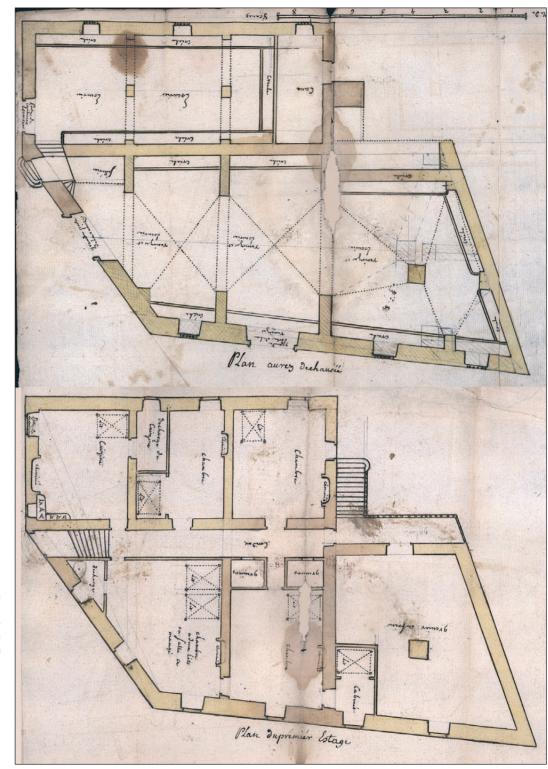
Plan de l'auberge de Laurent Parlier en 1753 : le rez-de-chaussée et le premier étage (AD48 39J, fonds Parlier-Chabrol).
